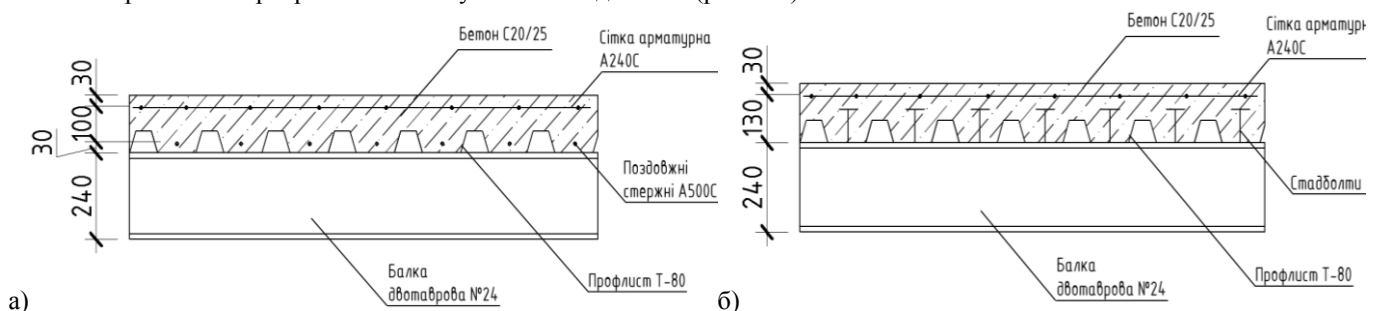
Конструкція перекриття: а) із застосуванням поздовжніх арматурних стержнів; б) із застосуванням стад болтів.
